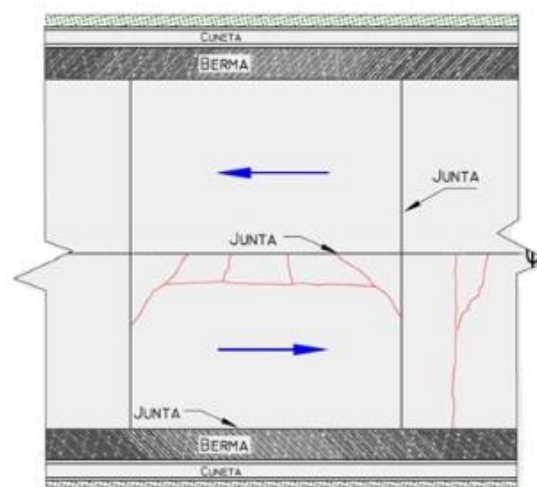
Grietas en bloque o fracturación múltiple (GB)
